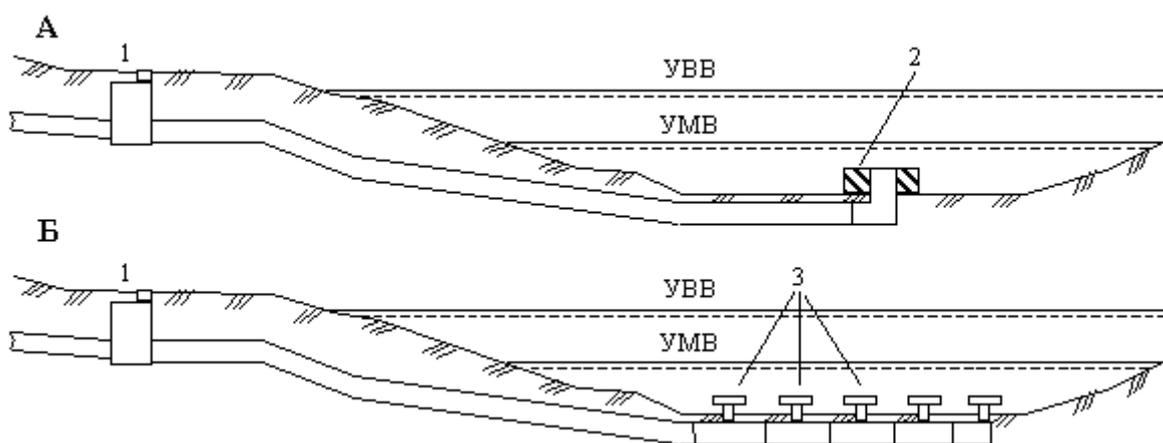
Схема русловых выпусков: А – сосредоточенный, Б – рассеивающий; 1 – береговой колодец, 2 – бетонный оголовок, 3 – оголовки с насадками; УВВ – высота самого высокого уровня подъема воды, УМВ – средний уровень воды в реке между паводками (половодьями)
